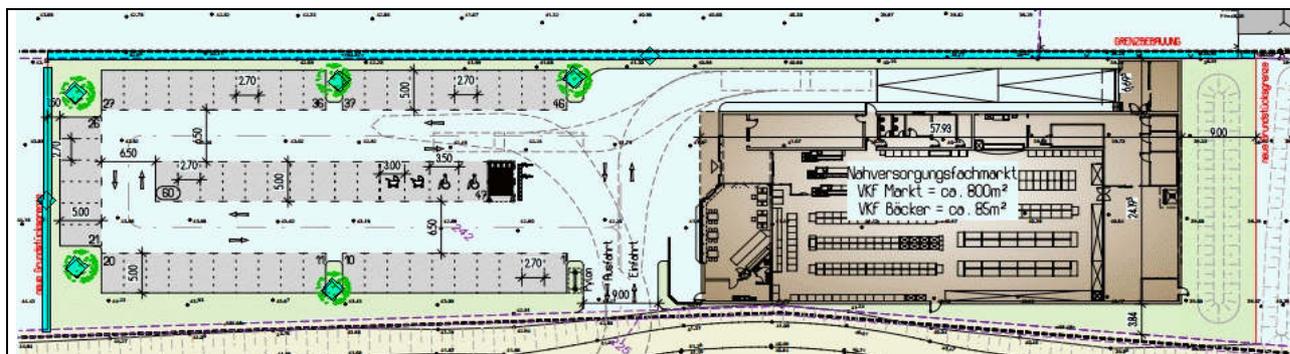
Lageplan des NVM samt Parkplatzfläche und vorgesehener Bepflanzung
